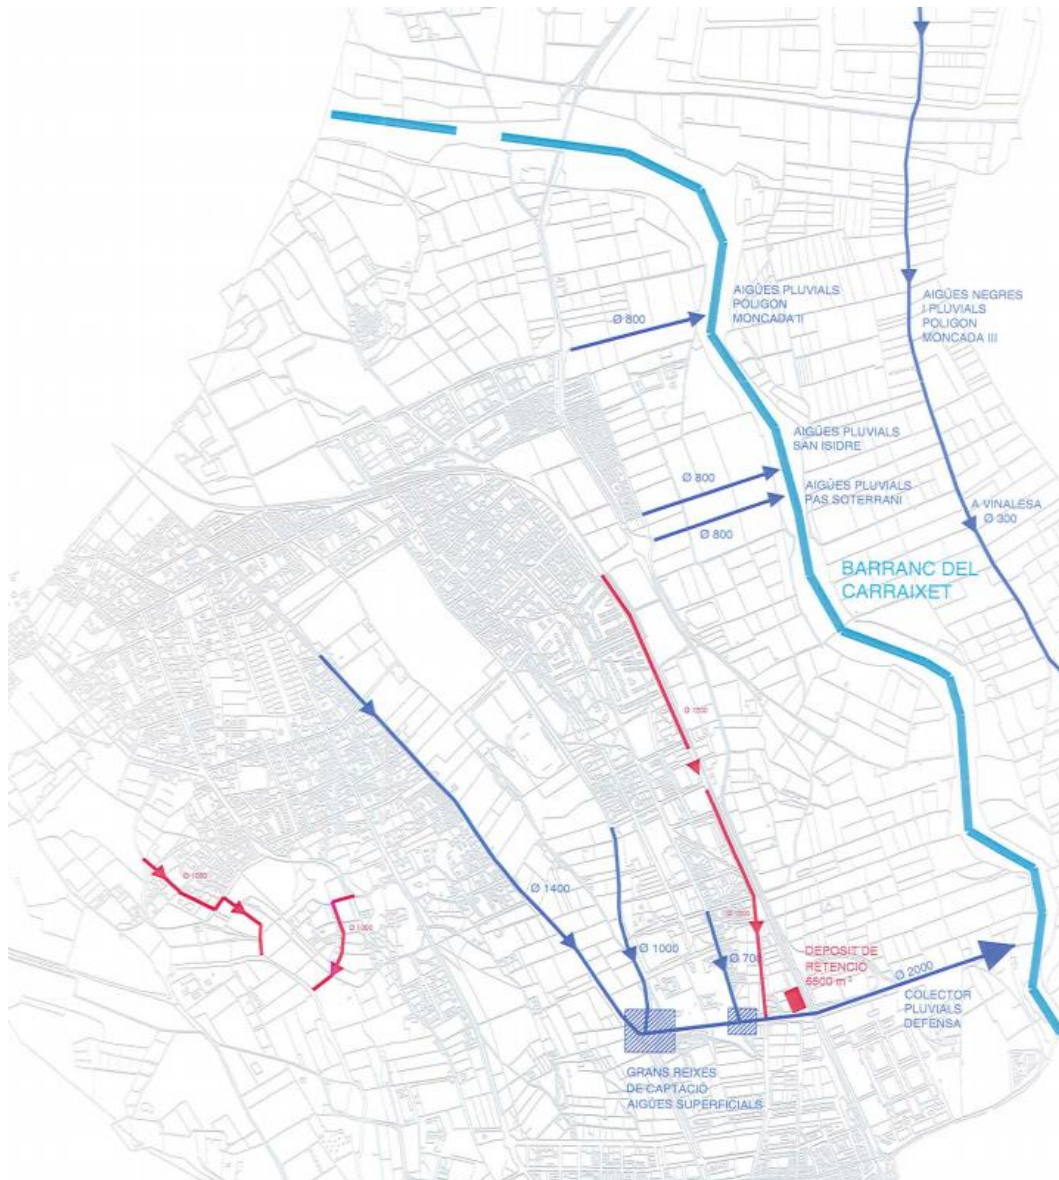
Imagen sobre plano de las infraestructuras existentes (Azul) y de las previstas en el Plan Director (rojo); (según el Plan Director de Saneamiento de Moncada).
